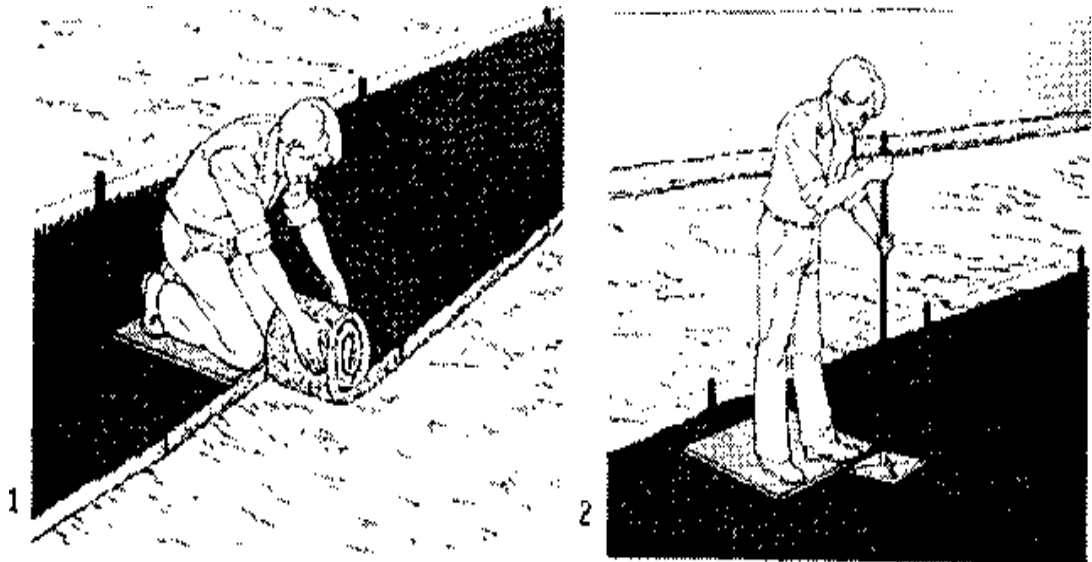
1 – схема укладки рулонного газону на спланованій поверхні;
